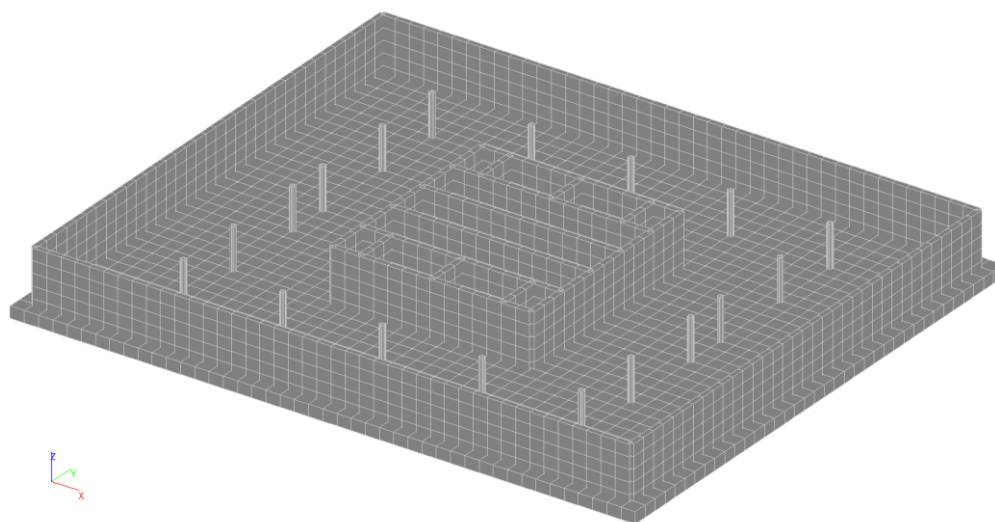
Конечно элементная схема фундаментной плиты
